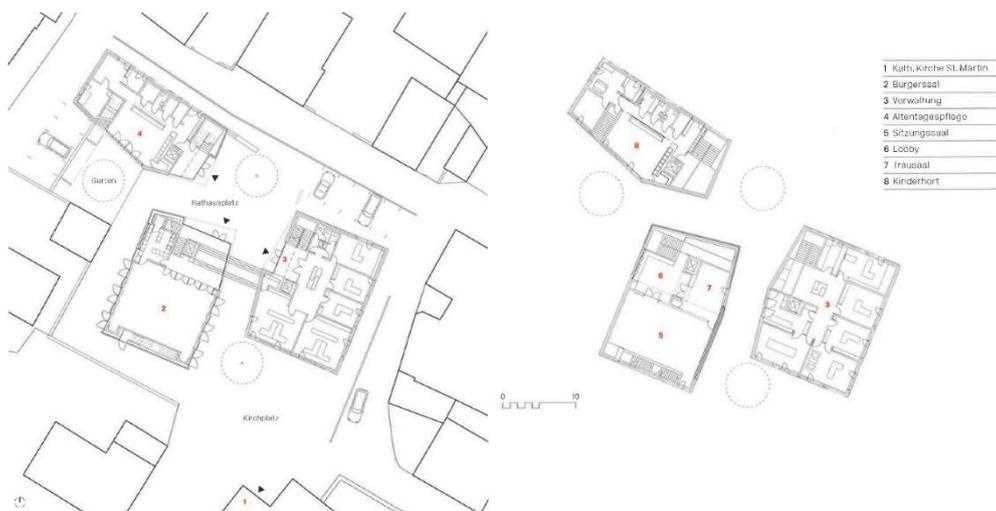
| Grundriss Erdgeschoss und Obergeschoss ³⁶
